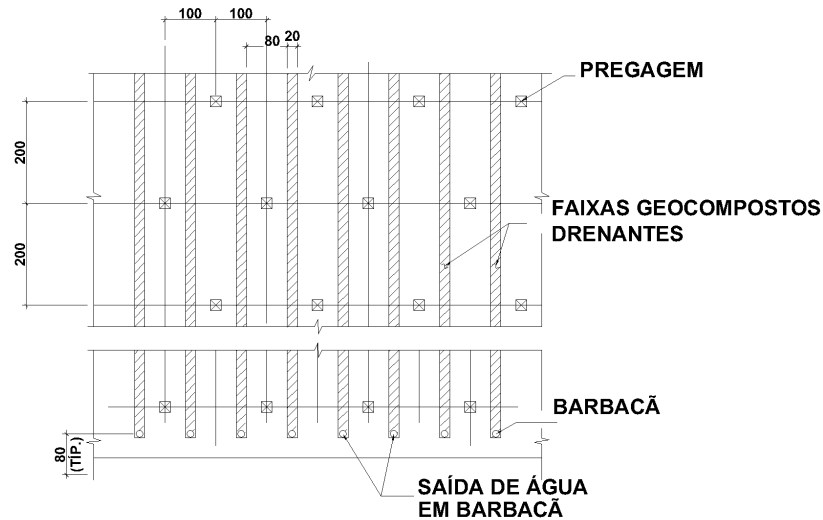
Instalação da manta geotêxtil ao longo do paramento de concreto projetado
